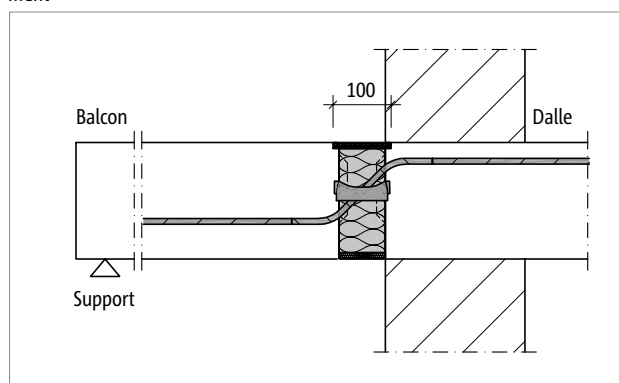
Schöck Isokorb® T Type Q-E-V avec REI120 : Plaque de protection incendie - haut, faisant saillie latéralement
